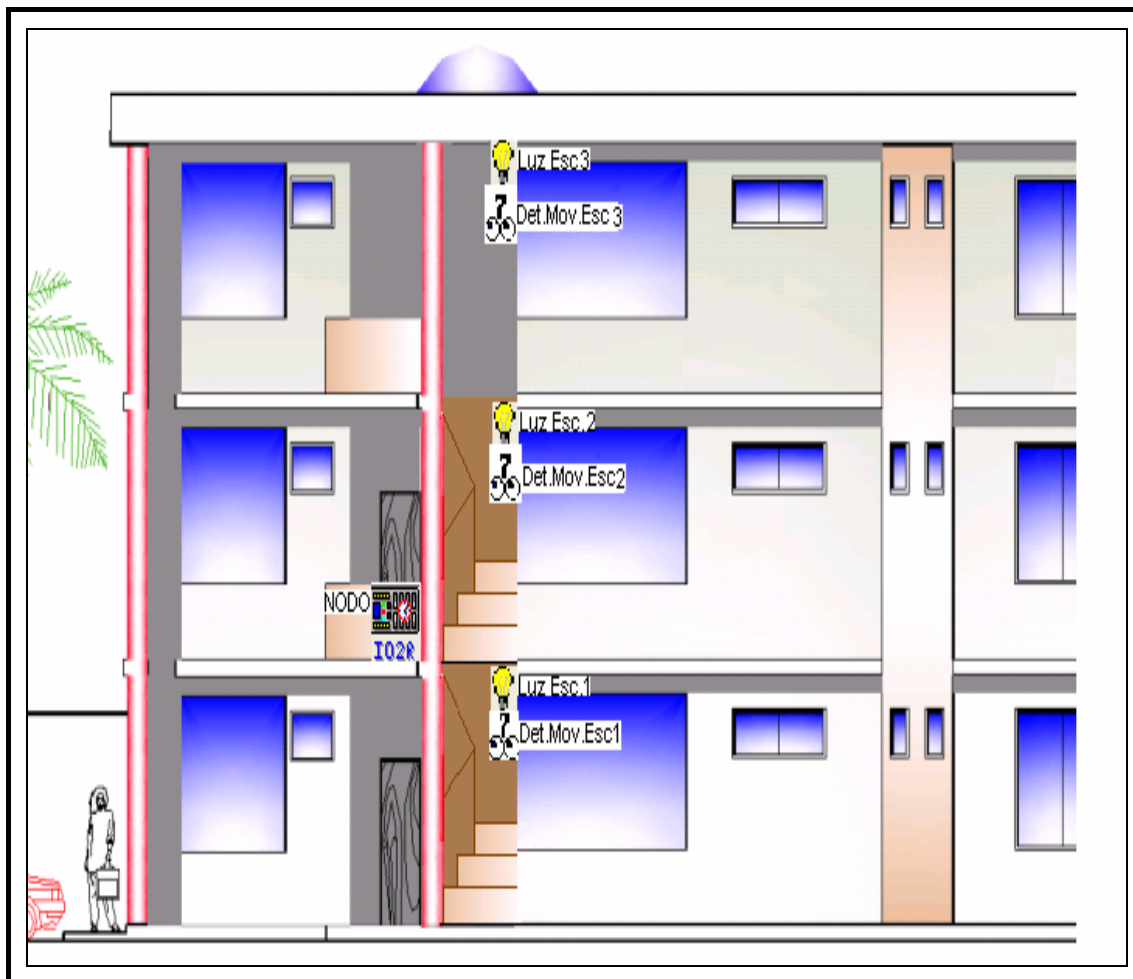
Diagrama Esquemático de Ubicación de Dispositivos de Sistema Iluminación Común por Planta
